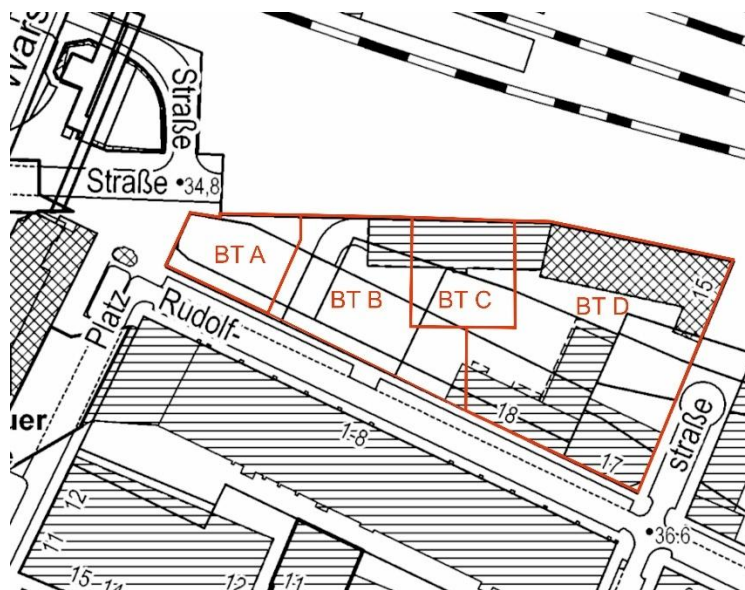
Darstellung der Grundstücke mit der Lage der Bauteile A, B, C und D
